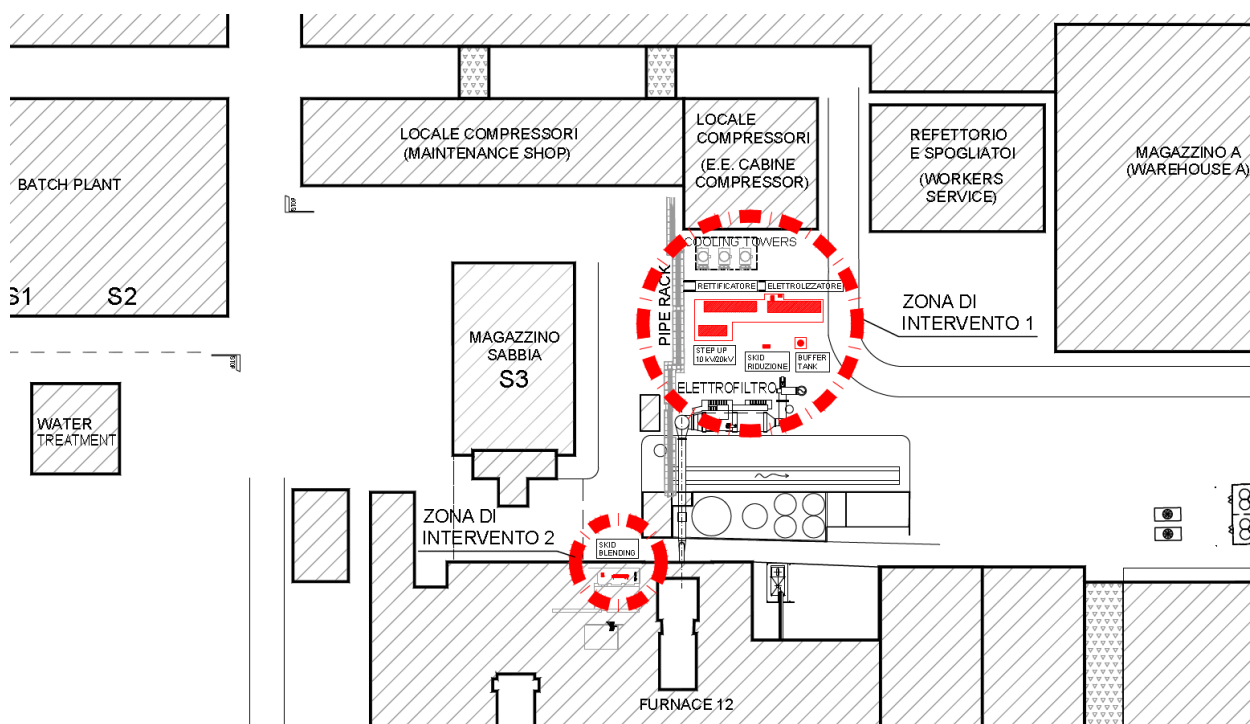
Layout di progetto con dettagli delle due zone di intervento
